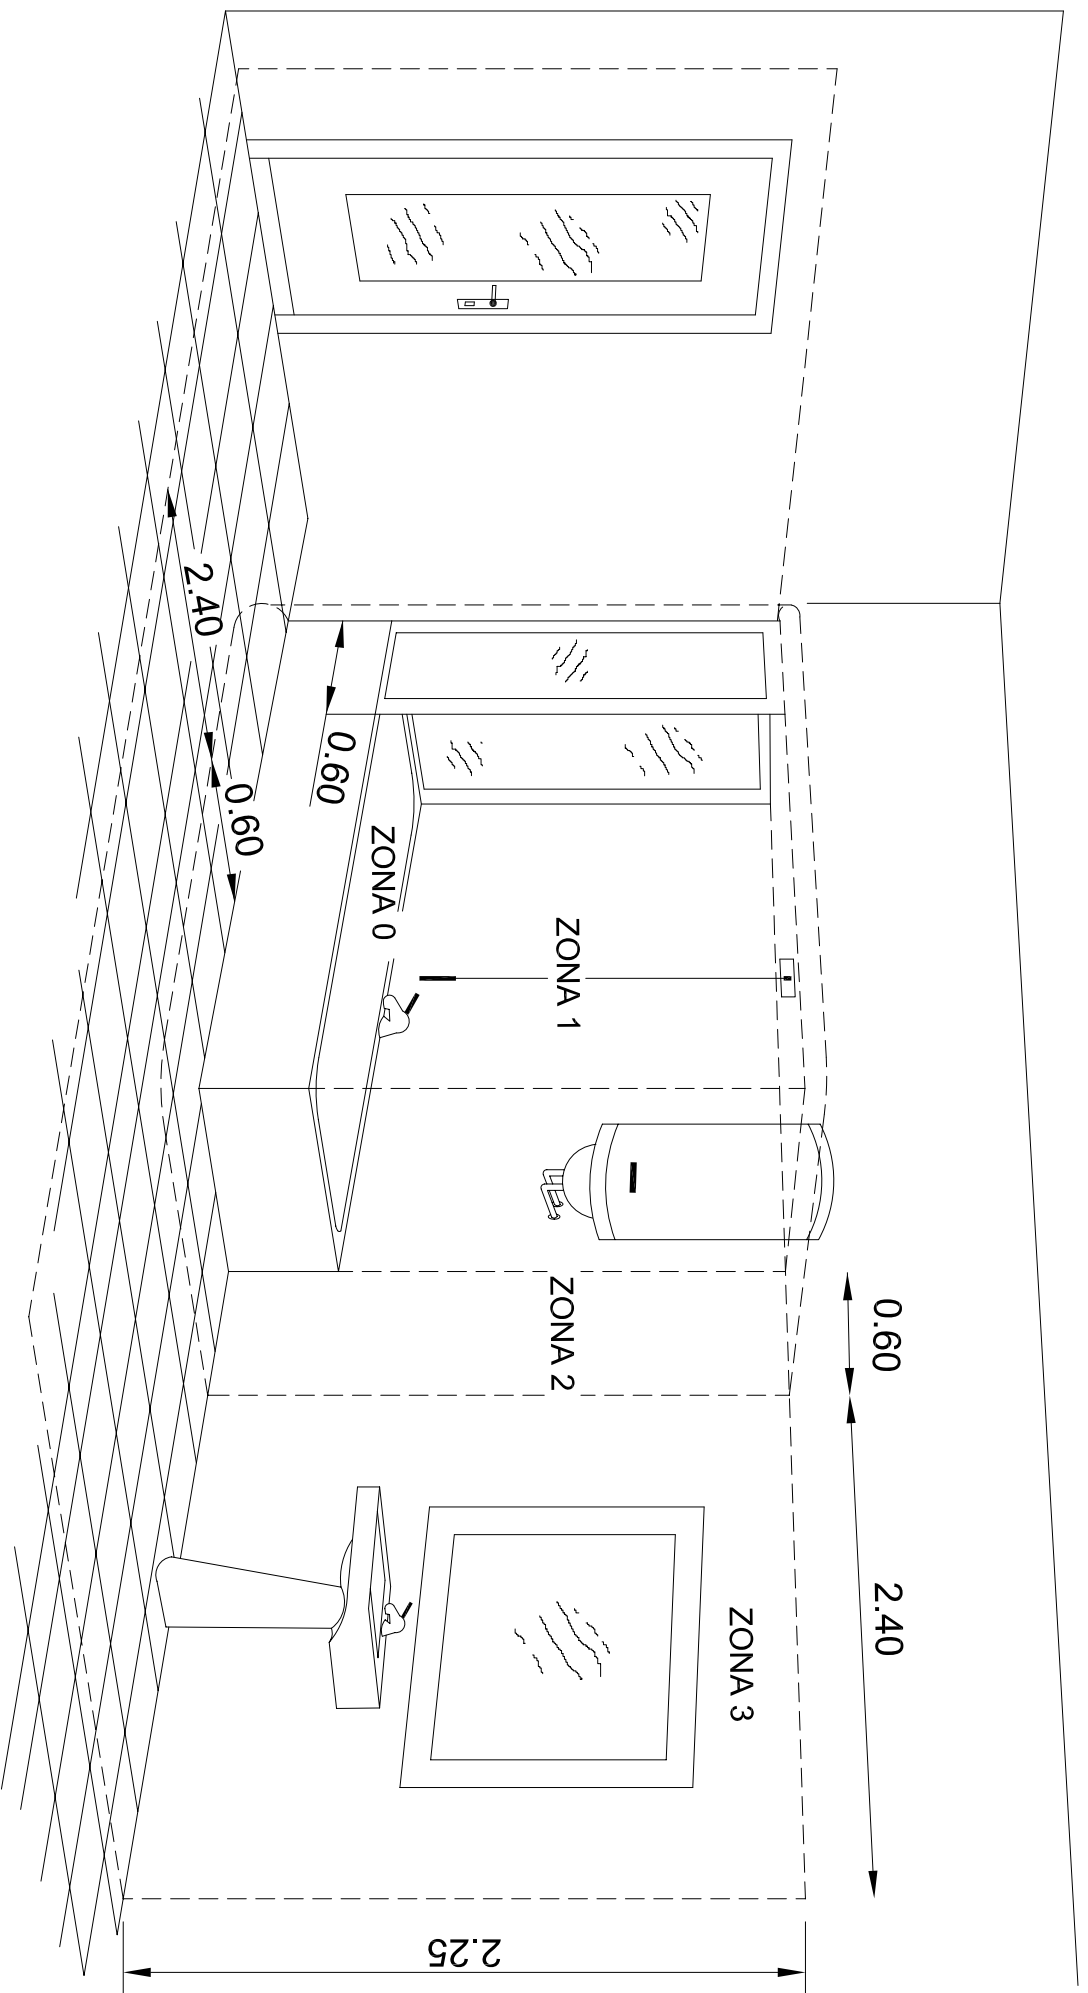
PARTICOLARE ALTEZZA DI INSTALLAZIONE PER GLI APPARECCHI DA INCASSO
